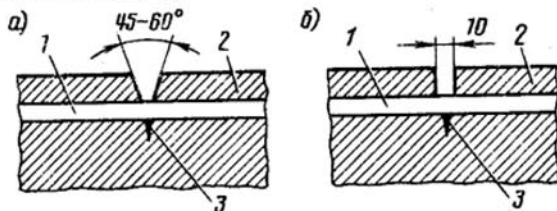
Схемы разделки трещин: 1 – арматурный стержень; 2 – защитный слой бетона; 3 – трещина
